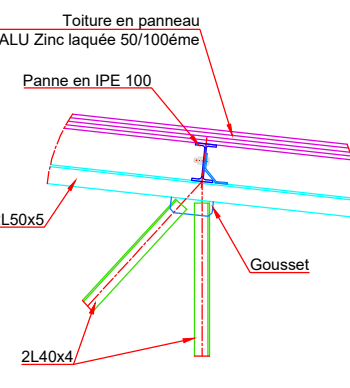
DETAIL TYPE POUTRE EN TREILLIS LATÉRALE
